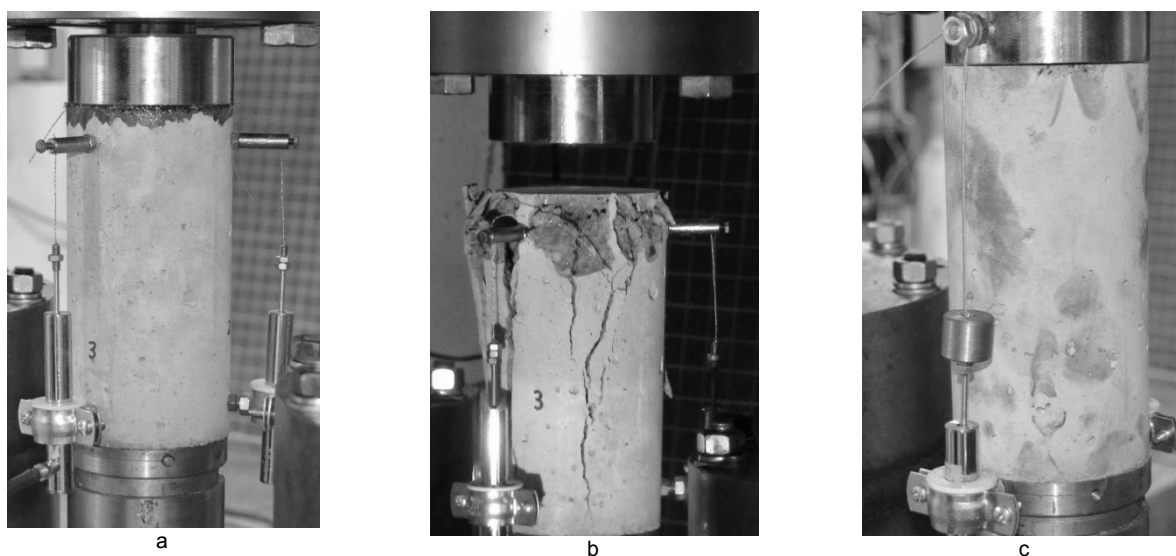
Moduri de fixare a traductorilor inductivi pe epruveta cilindrică / Modes of connecting the LVDTs on the cylindrical specimen: a, b - pe epruvetă / on the specimen; c - pe platanele preseii / on the testing machine plates.
